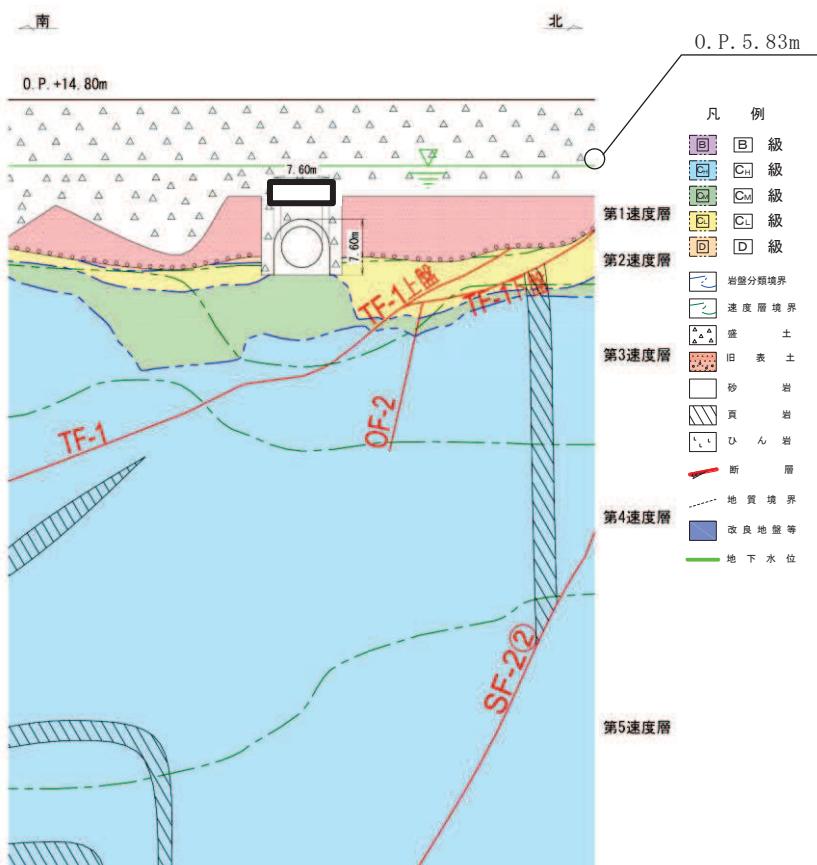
排気筒連絡ダクト（土砂部）の地質断面図（断面③）
